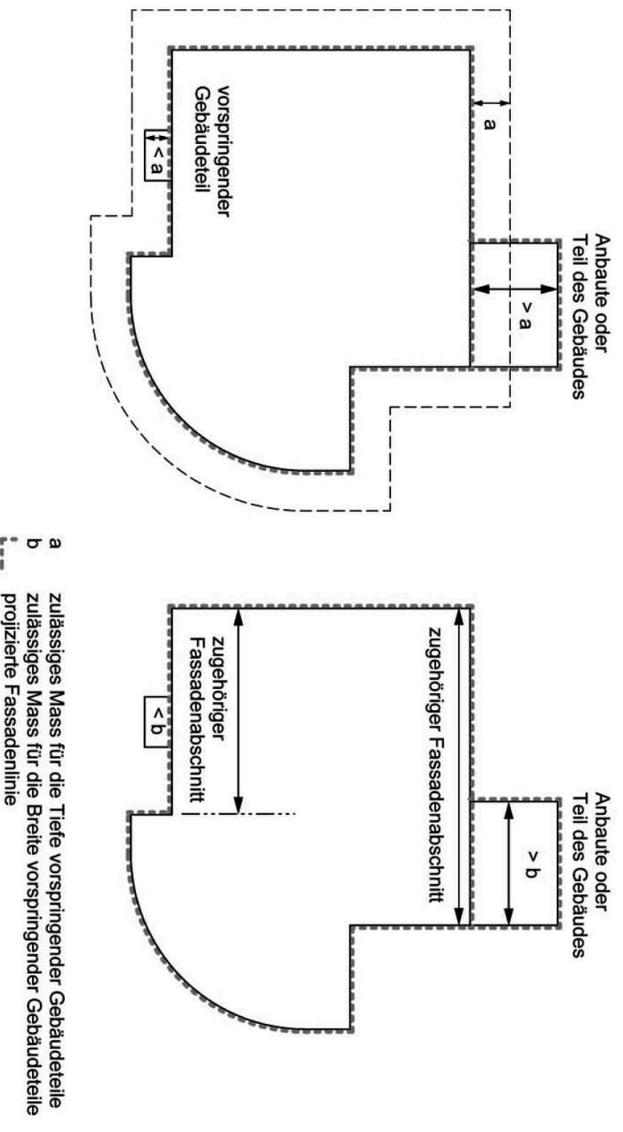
a Fassadenflucht und Fassadenlinie (in ebenem Gelände)
